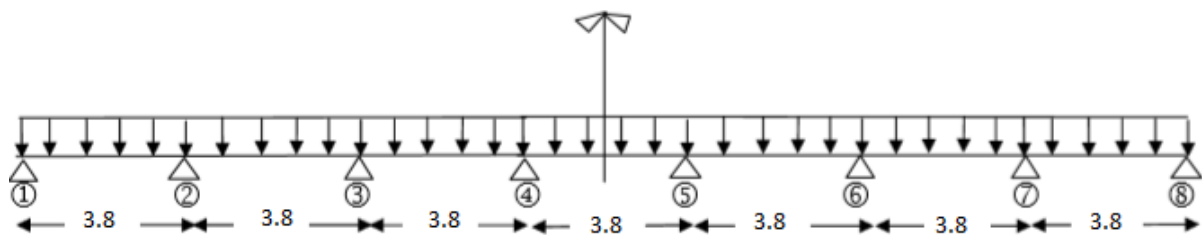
Schéma statique de la poutrelle à 7 travées.
